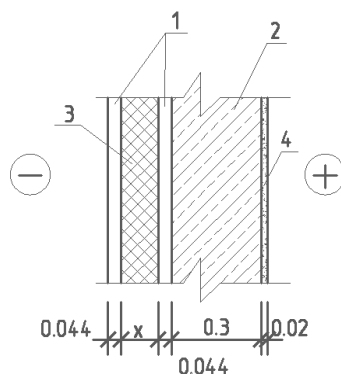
Конструкция стены (ниже 0.000) стены
